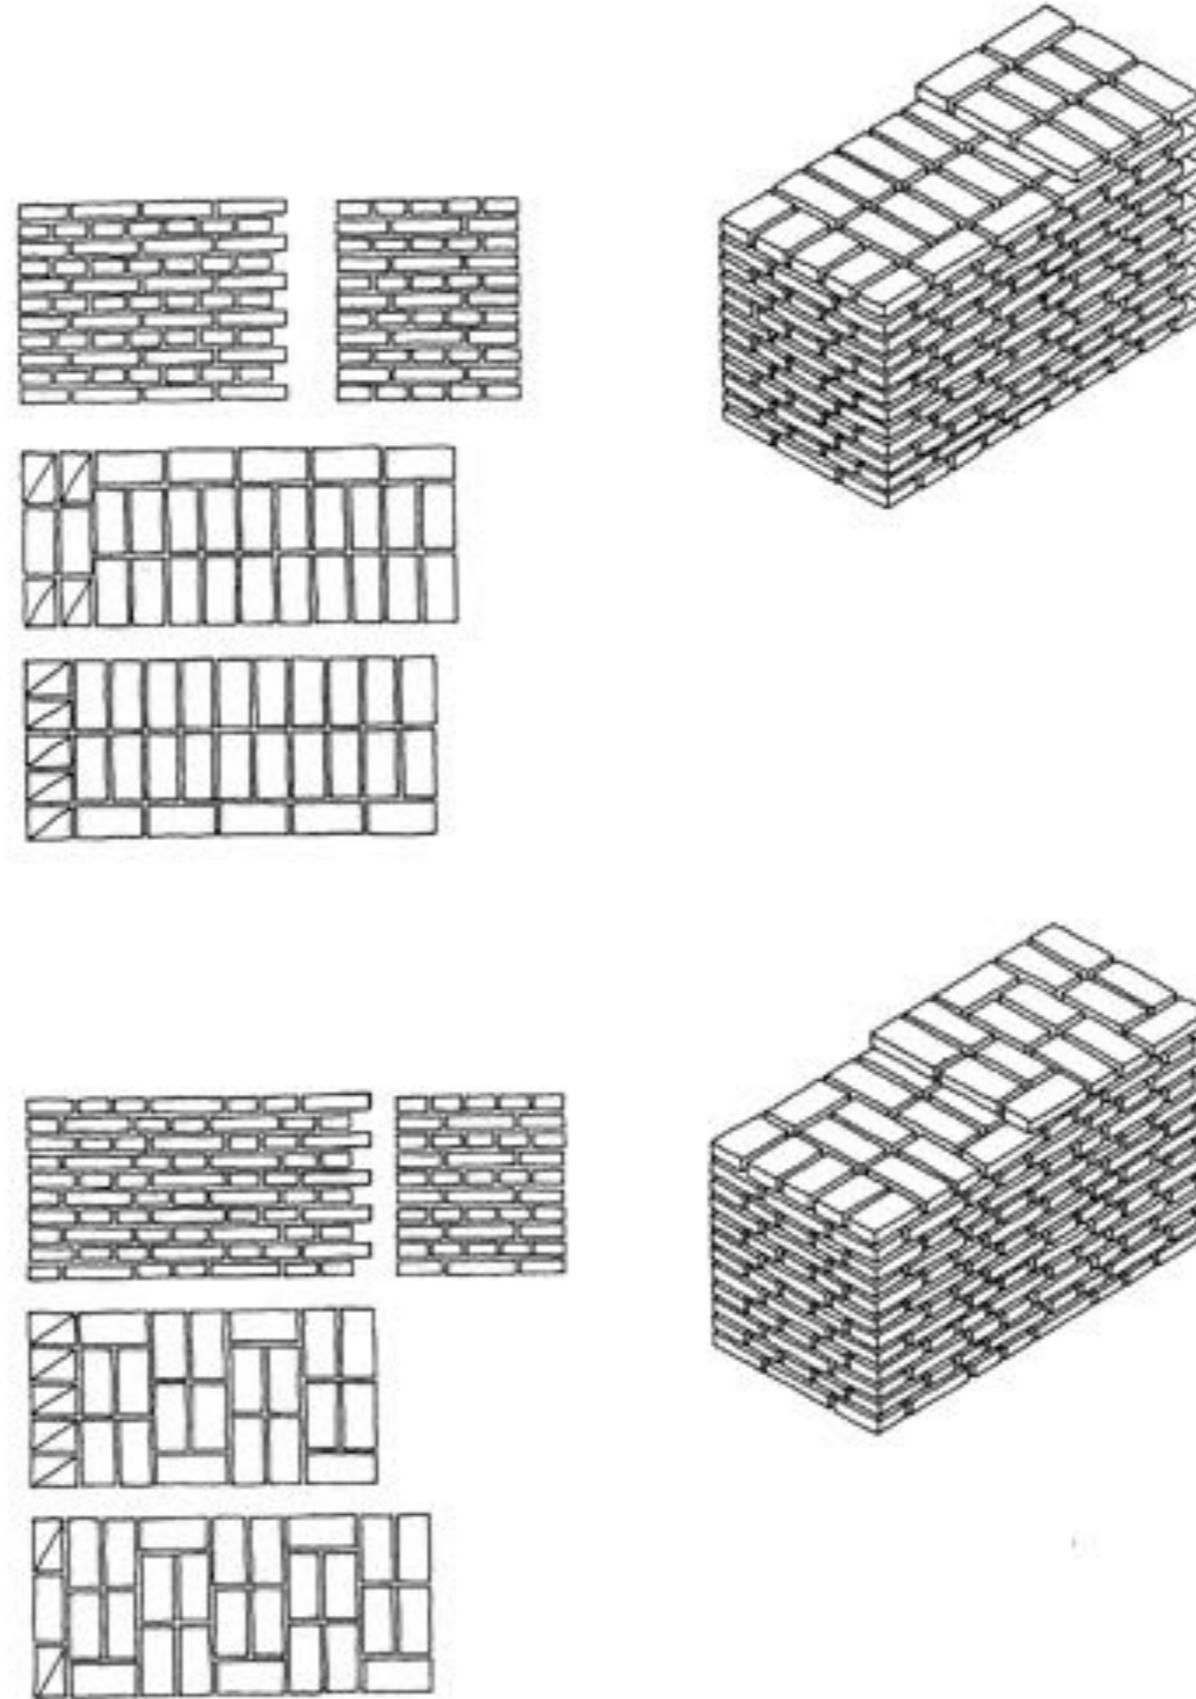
Schema in alto: muro a cinque teste: concatenamento a blocco. Veduta assonometrica, prospetto, sezione e pianta dei corsi di mattoni; schema in basso: muro a cinque teste: concatenamento in chiave. Veduta assonometrica, prospetto, sezione e pianta dei corsi di mattoni
